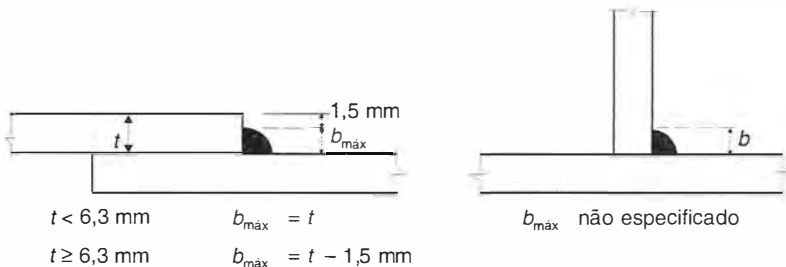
Dimensões máximas dos lados de filetes de solda.
